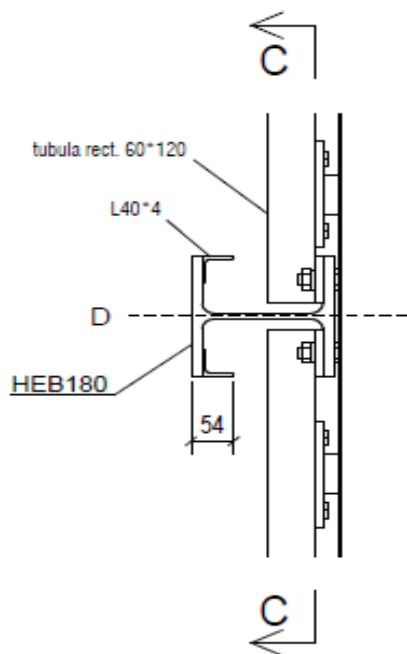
Pormenor da ligação entre o patamar e o pilar central
